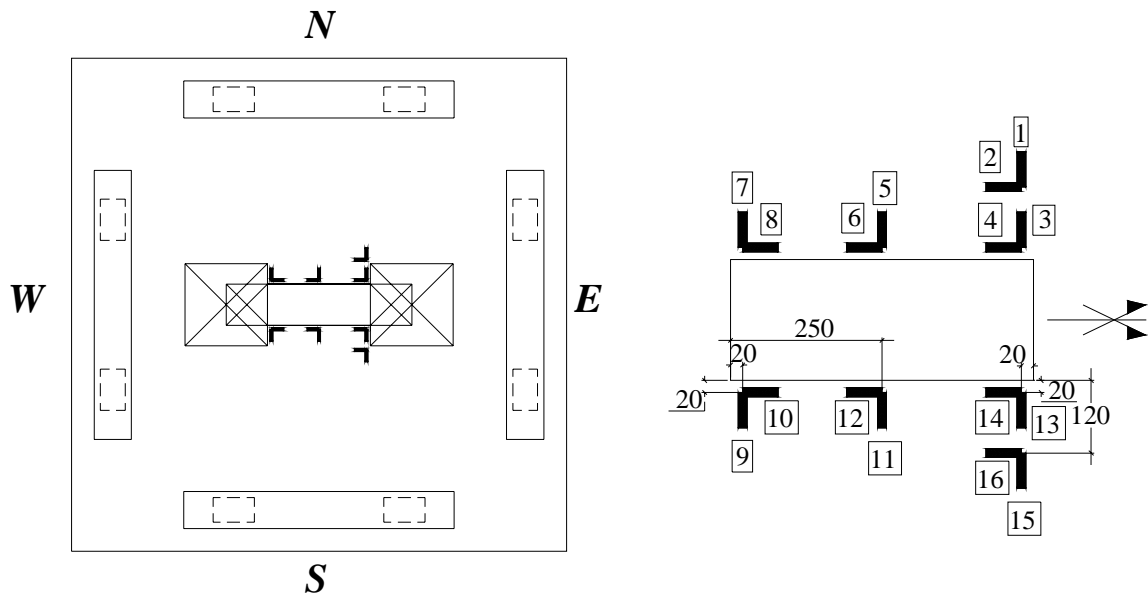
Posicionamento dos EERs do concreto nas lajes L5 a L13 (mm)
